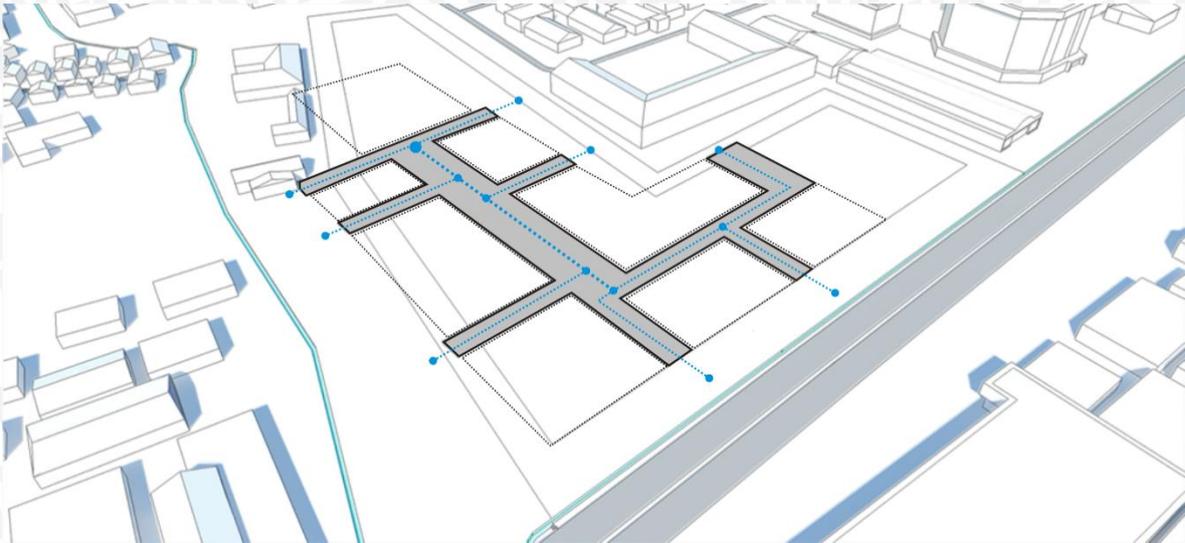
114 Rencana Fasilitas Dalam Area Terbangun
